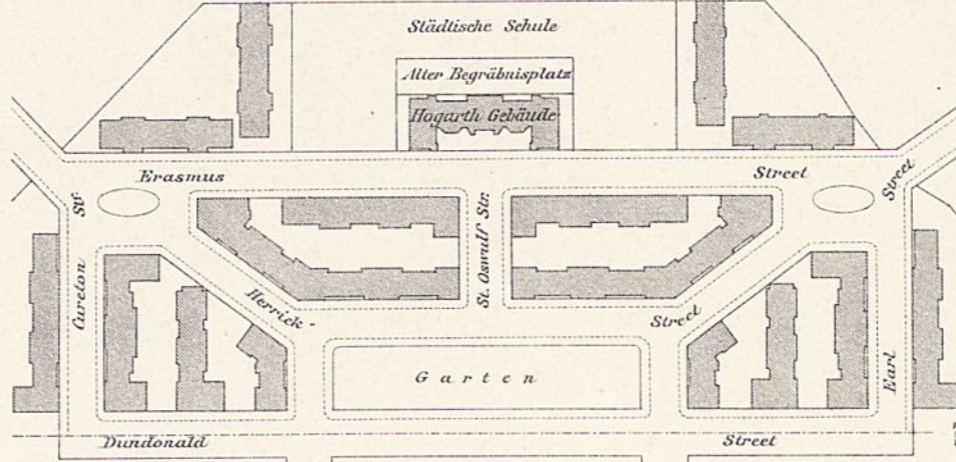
Bebauungsplan des Millbank- Grundstückes in London.
